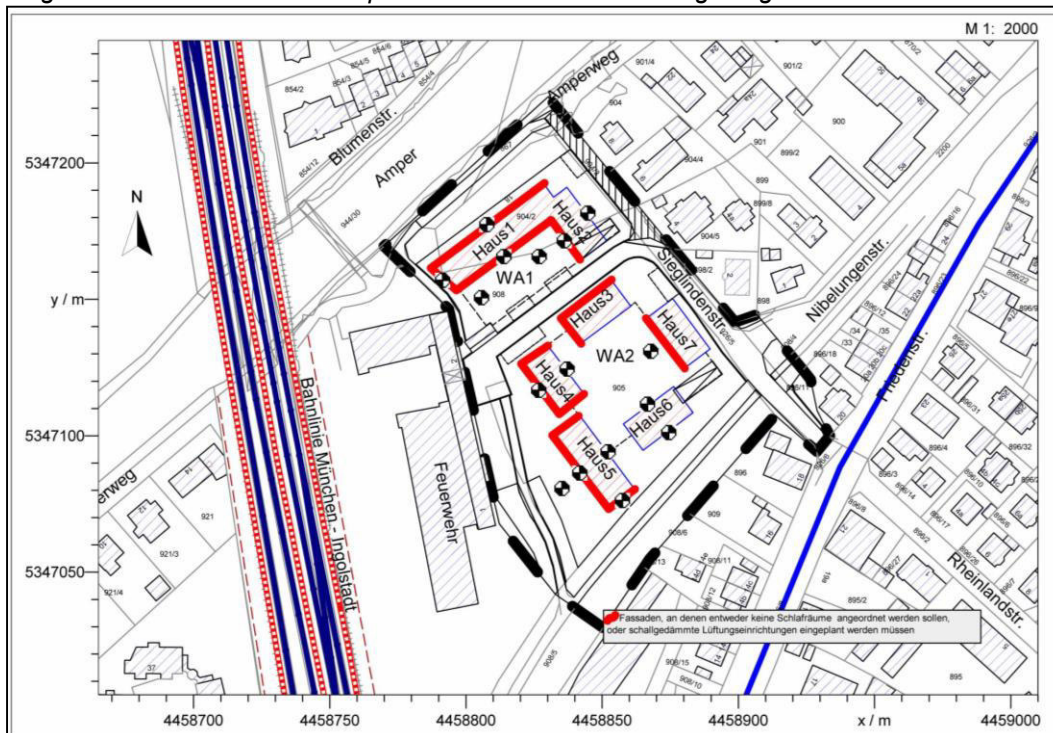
Fassadenkennzeichnung passiver Schallschutz, Möhler+Partner, Anlage 6.2 zu Bericht 070-3783
